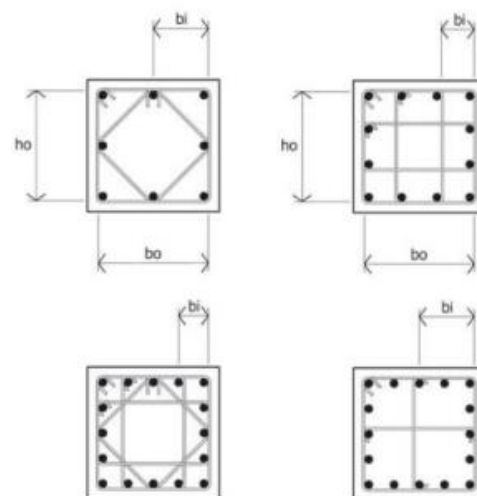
Pormenorização típica de pilares em corte (adaptado de Amaral, 2012).
